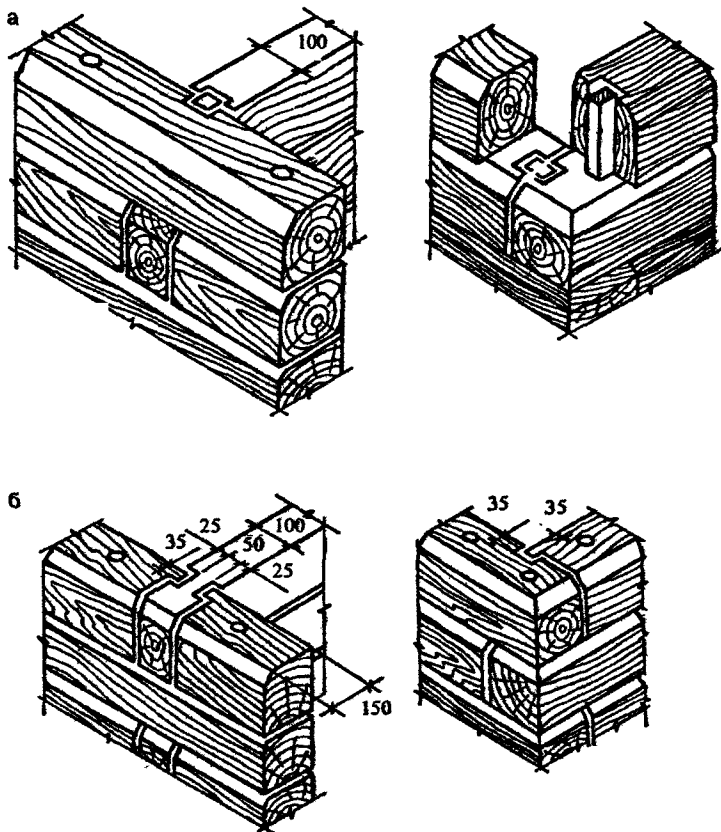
Примыкание деревянных брусчатых стен и сопряжение угла:
